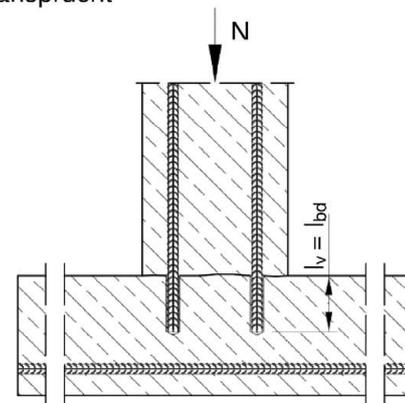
Übergreifungsstoß einer Stütze oder Wand an ein Fundament; Bewehrungsstäbe auf Zug beansprucht
